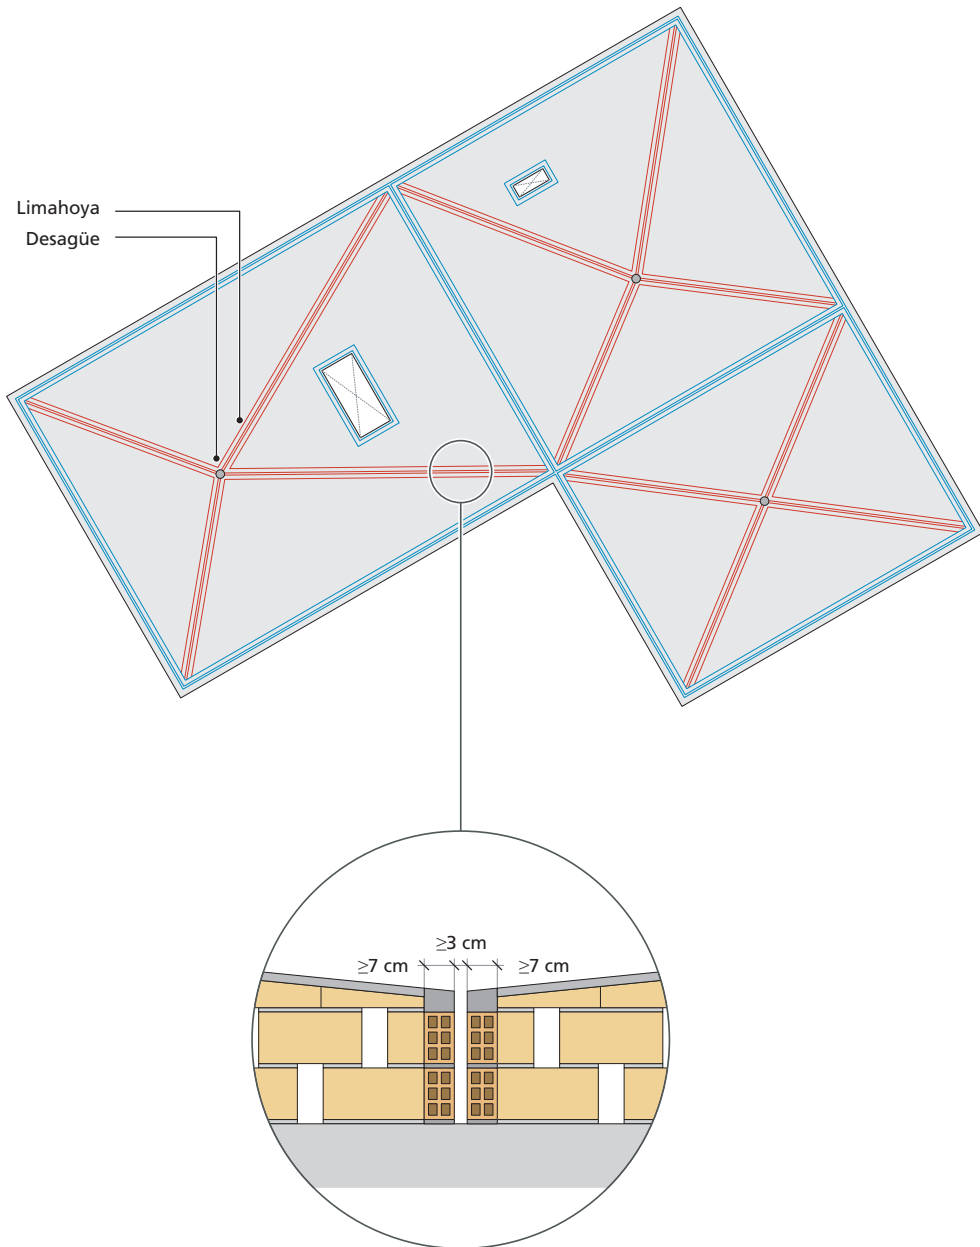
Replanteo de tabiques palomeros delimitadores de elementos sobreelevados y de contorno de los planos de desagüe en cubierta plana sobre forjado
